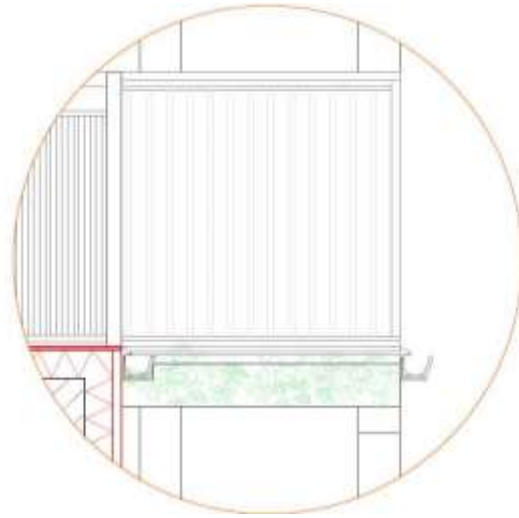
DETALL ESTRUCTURA BALCÓ.
